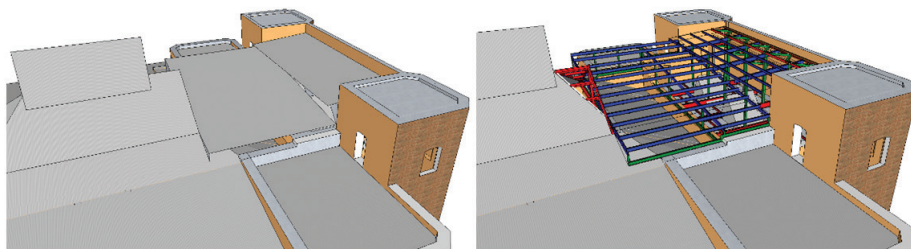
Vista general de la cubierta (izq) y estructura de sostén (der)
